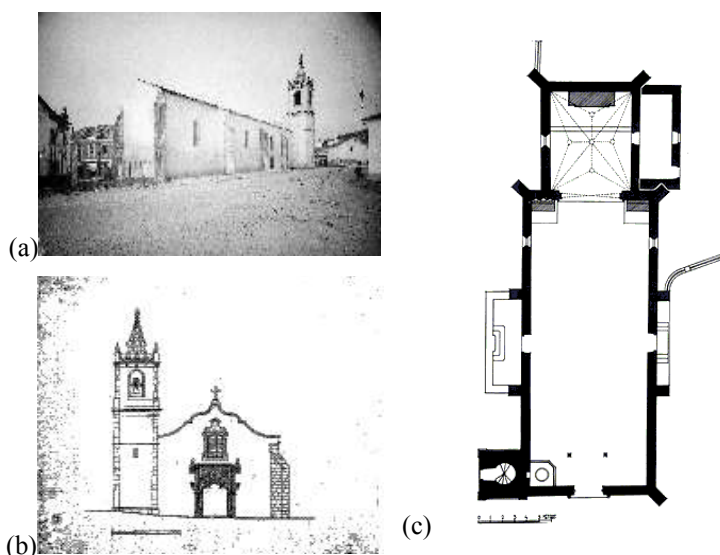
Peças desenhadas [Fonte: DGEMN]: (a) fotografia; (b) alçado frontal (Oeste); (c) planta.
